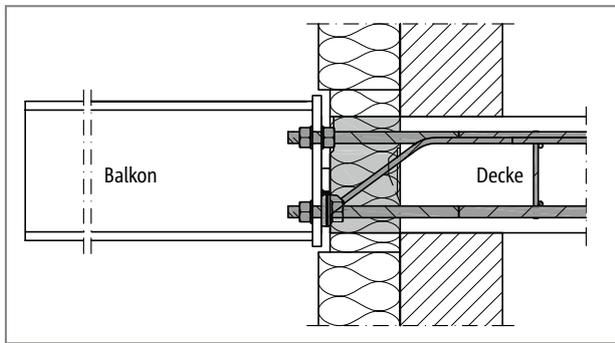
Schöck Isokorb® XT Typ SK: Anschluss an die Stahlbetondecke; Dämmkörper innerhalb der Außendämmung
